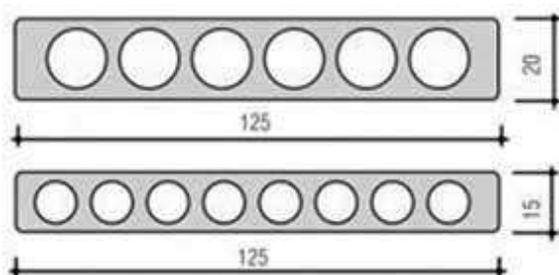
Seção transversal de um painel alveolar com largura e espessuras típicas. (CASSOL, 2012)
